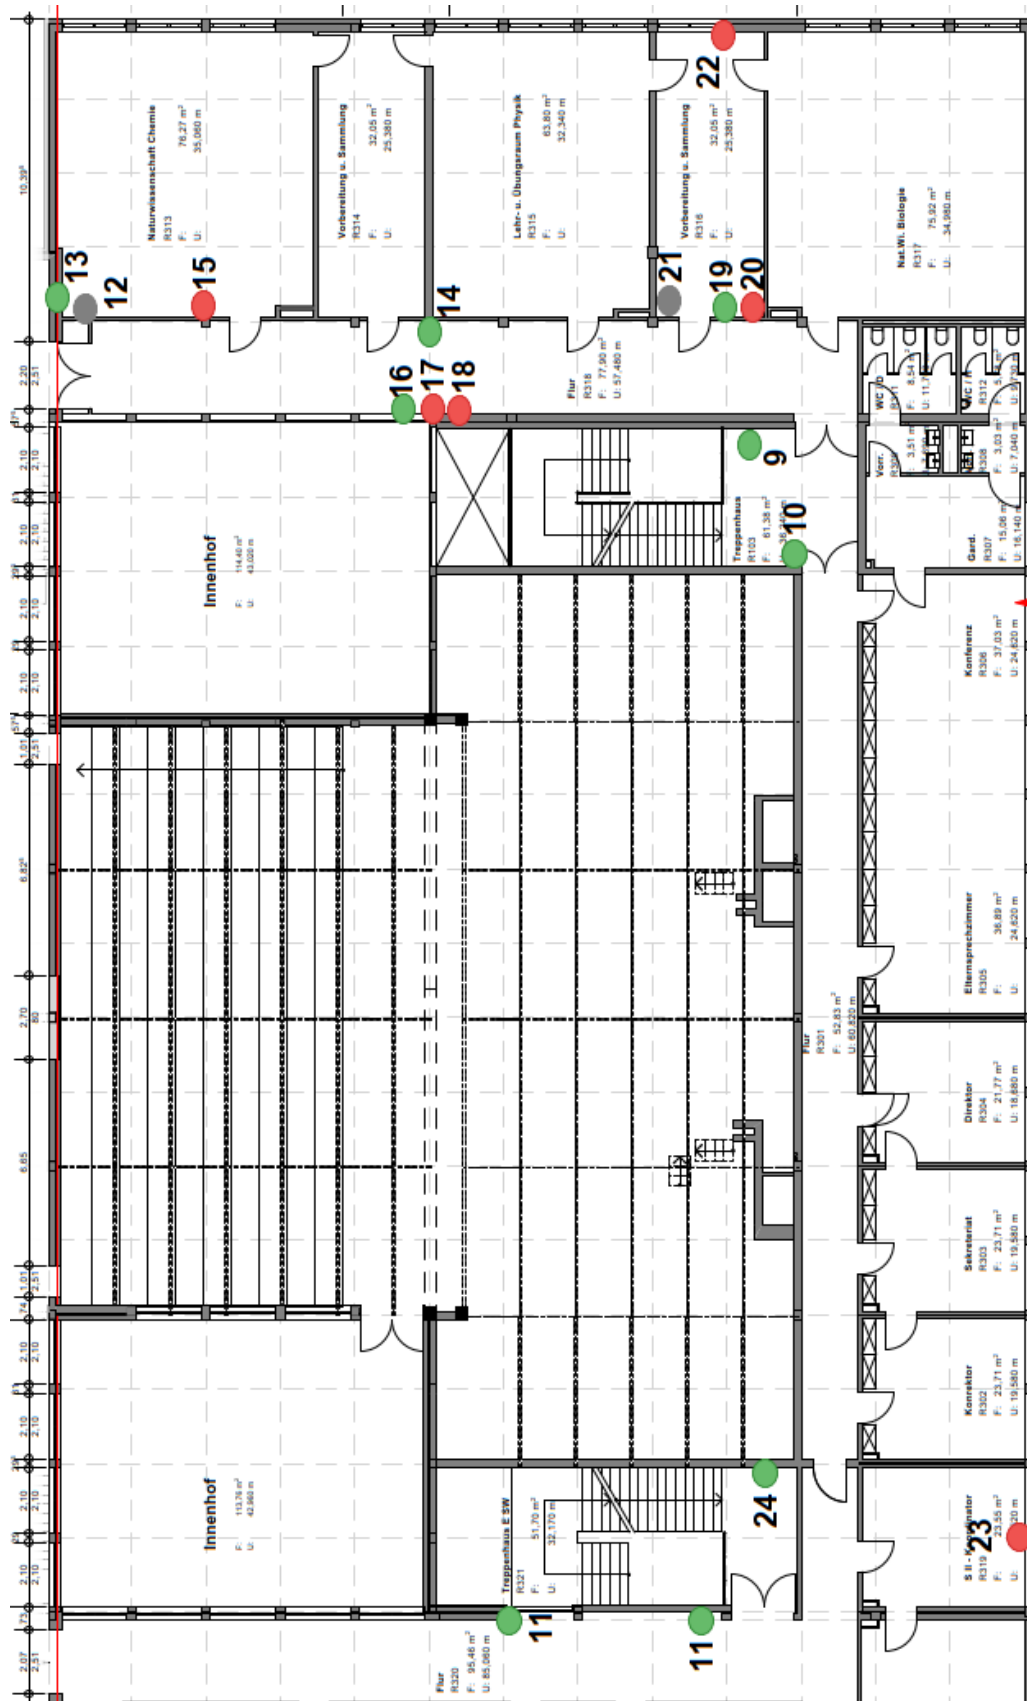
Grundrissausschnitt Ebene 3 (grün = ohne Befund, rot = Befund)
